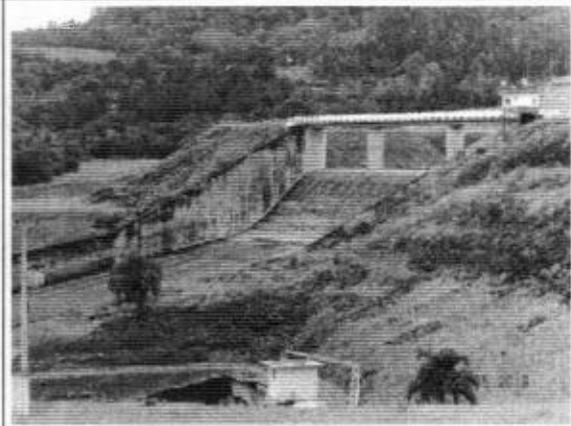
Taludes de jusante e vertedouro central sobre-elevado.
